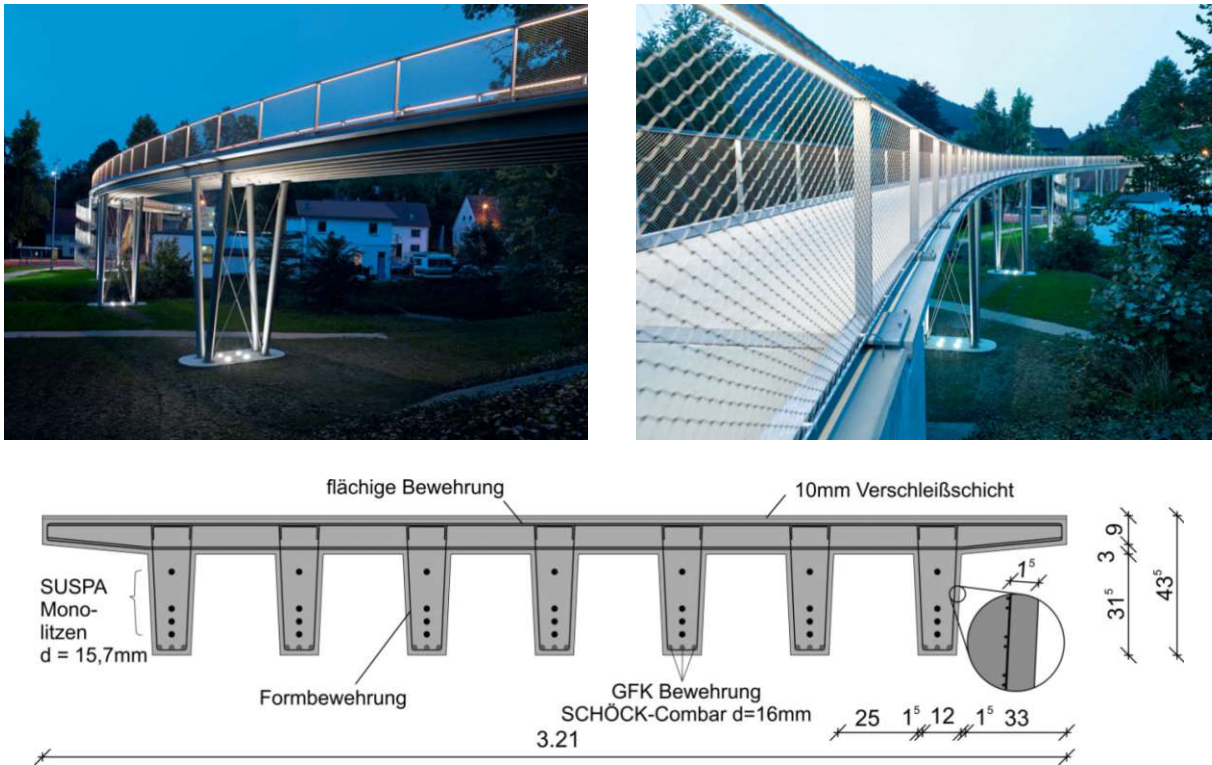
Ansicht und Querschnitt der Textilbeton-Fußgängerbrücke in Albstadt-Lautlingen, entnommen aus [63].
